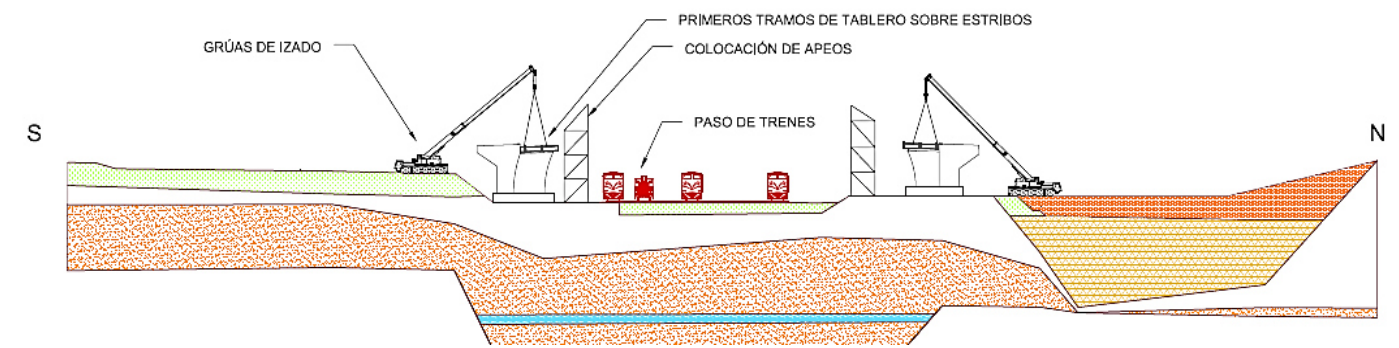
IZADO PRIMER TRAMO DE TABLERO Y COLOCACIÓN DE APEOS.
